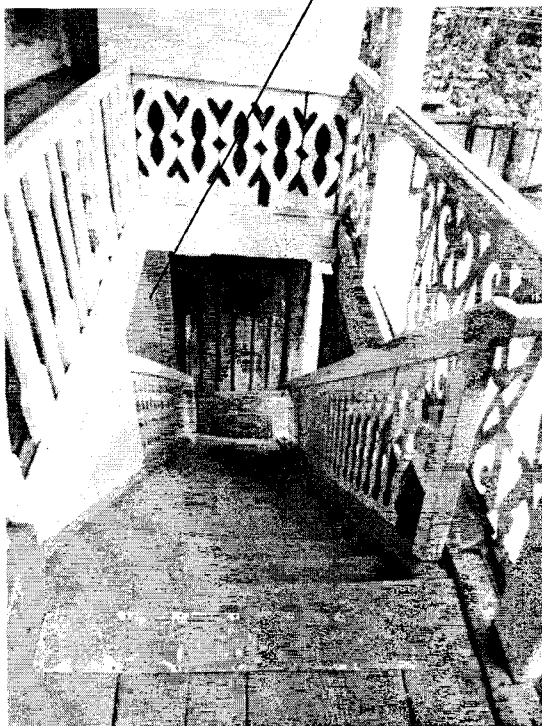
, 21 - Фрагменты продольного, дворового (северо-восточного) фасада открытой галереи, 2-ой этаж. Лестница на 2-ой этаж
